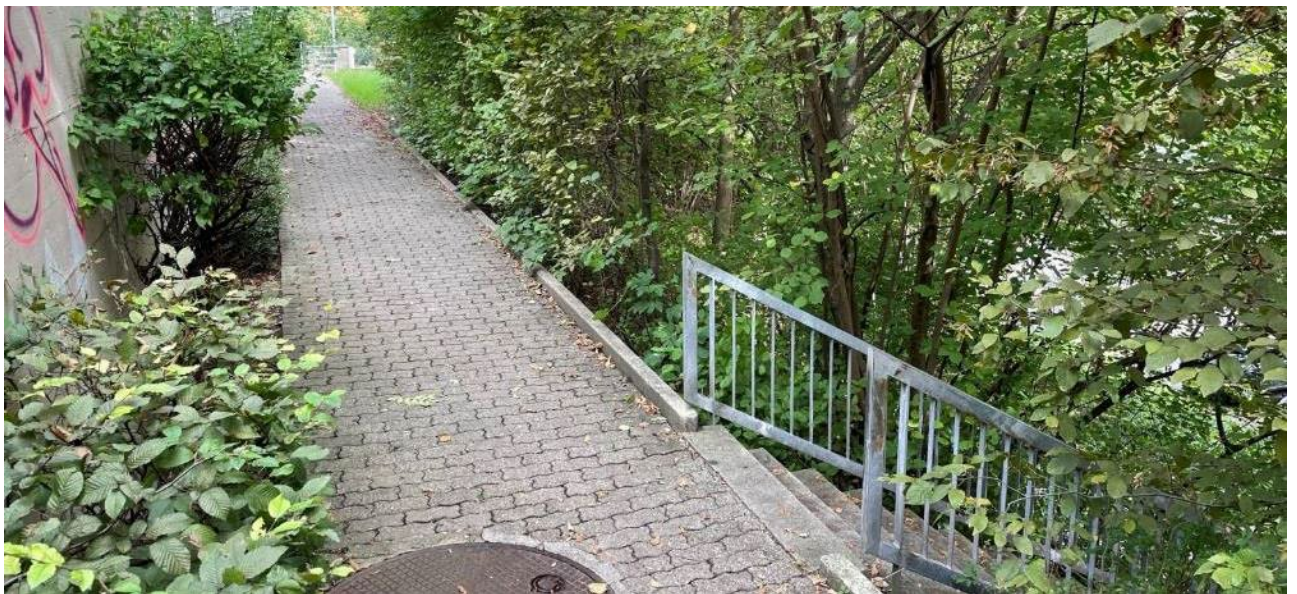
Bestehende aber unattraktive Wegführung entlang Hangkante (Quelle: Planung und Bau 2023).
